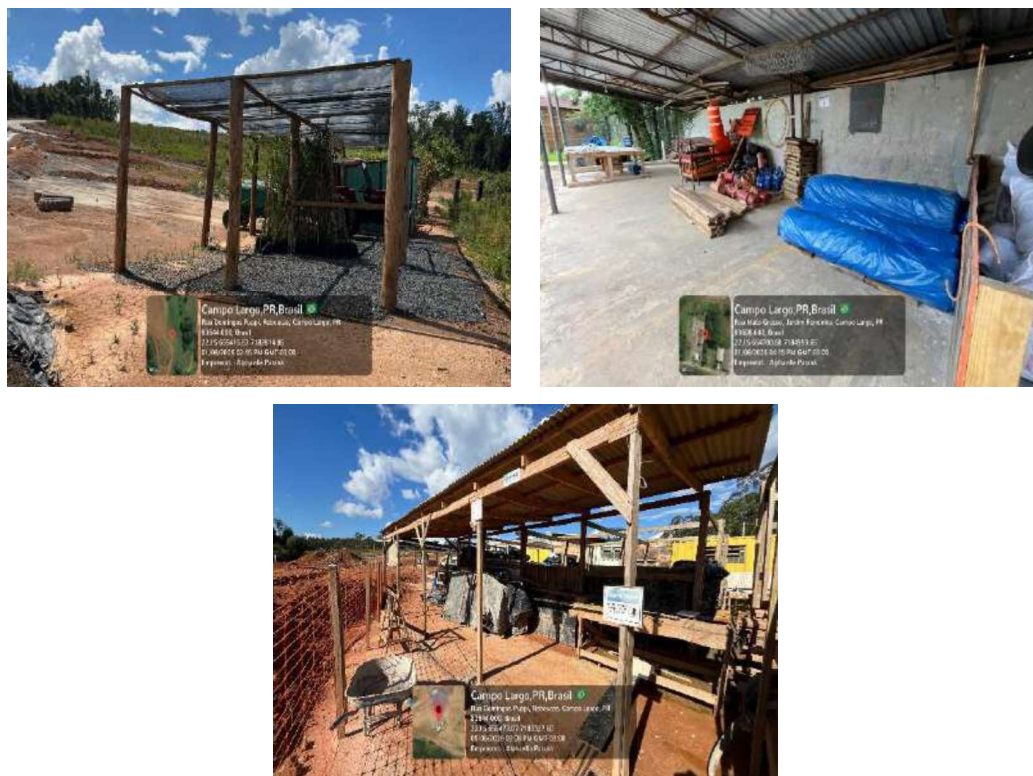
Estruturas provisórias de Canteiro de Obras / Áreas de Apoio
